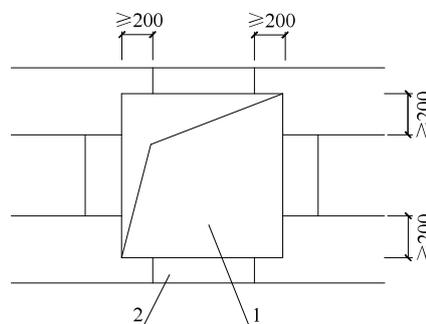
门窗洞口保温板排板示意（尺寸单位：mm）
